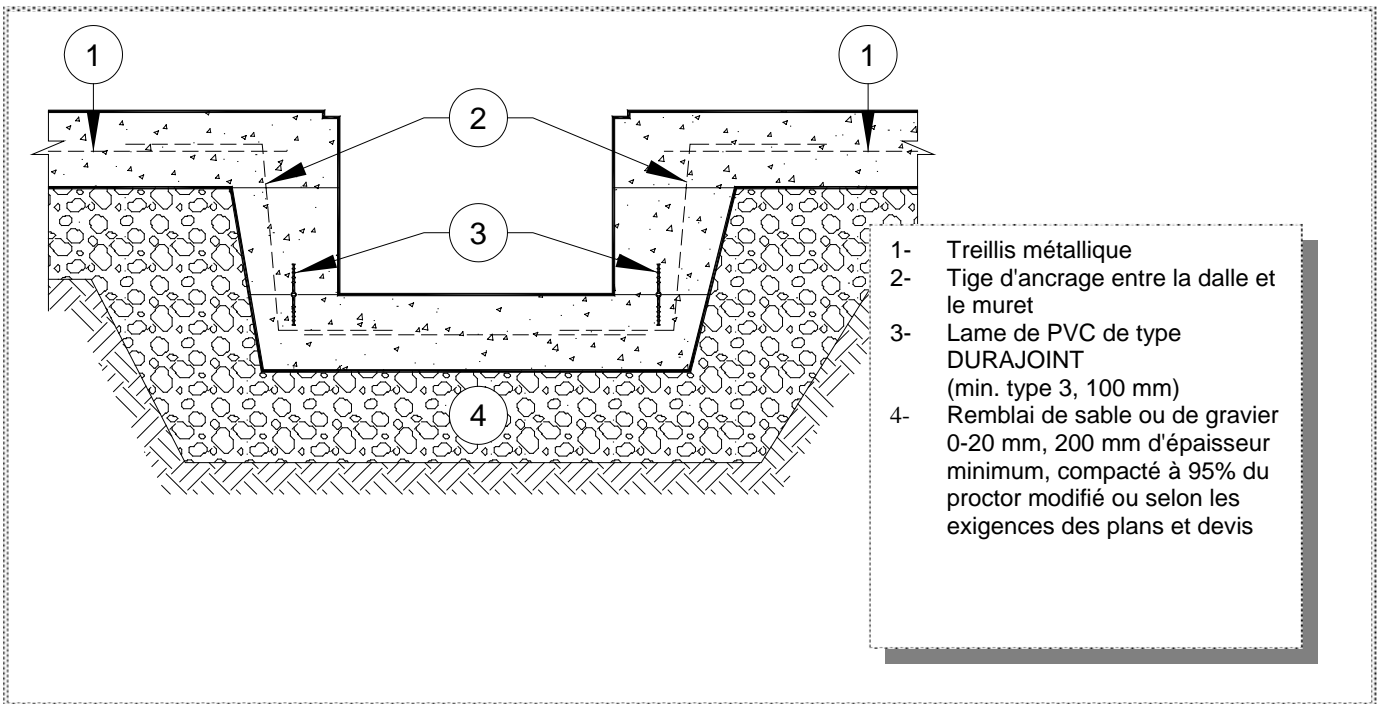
Étanchéité d'une rigole de nettoyage (Joint de construction)
